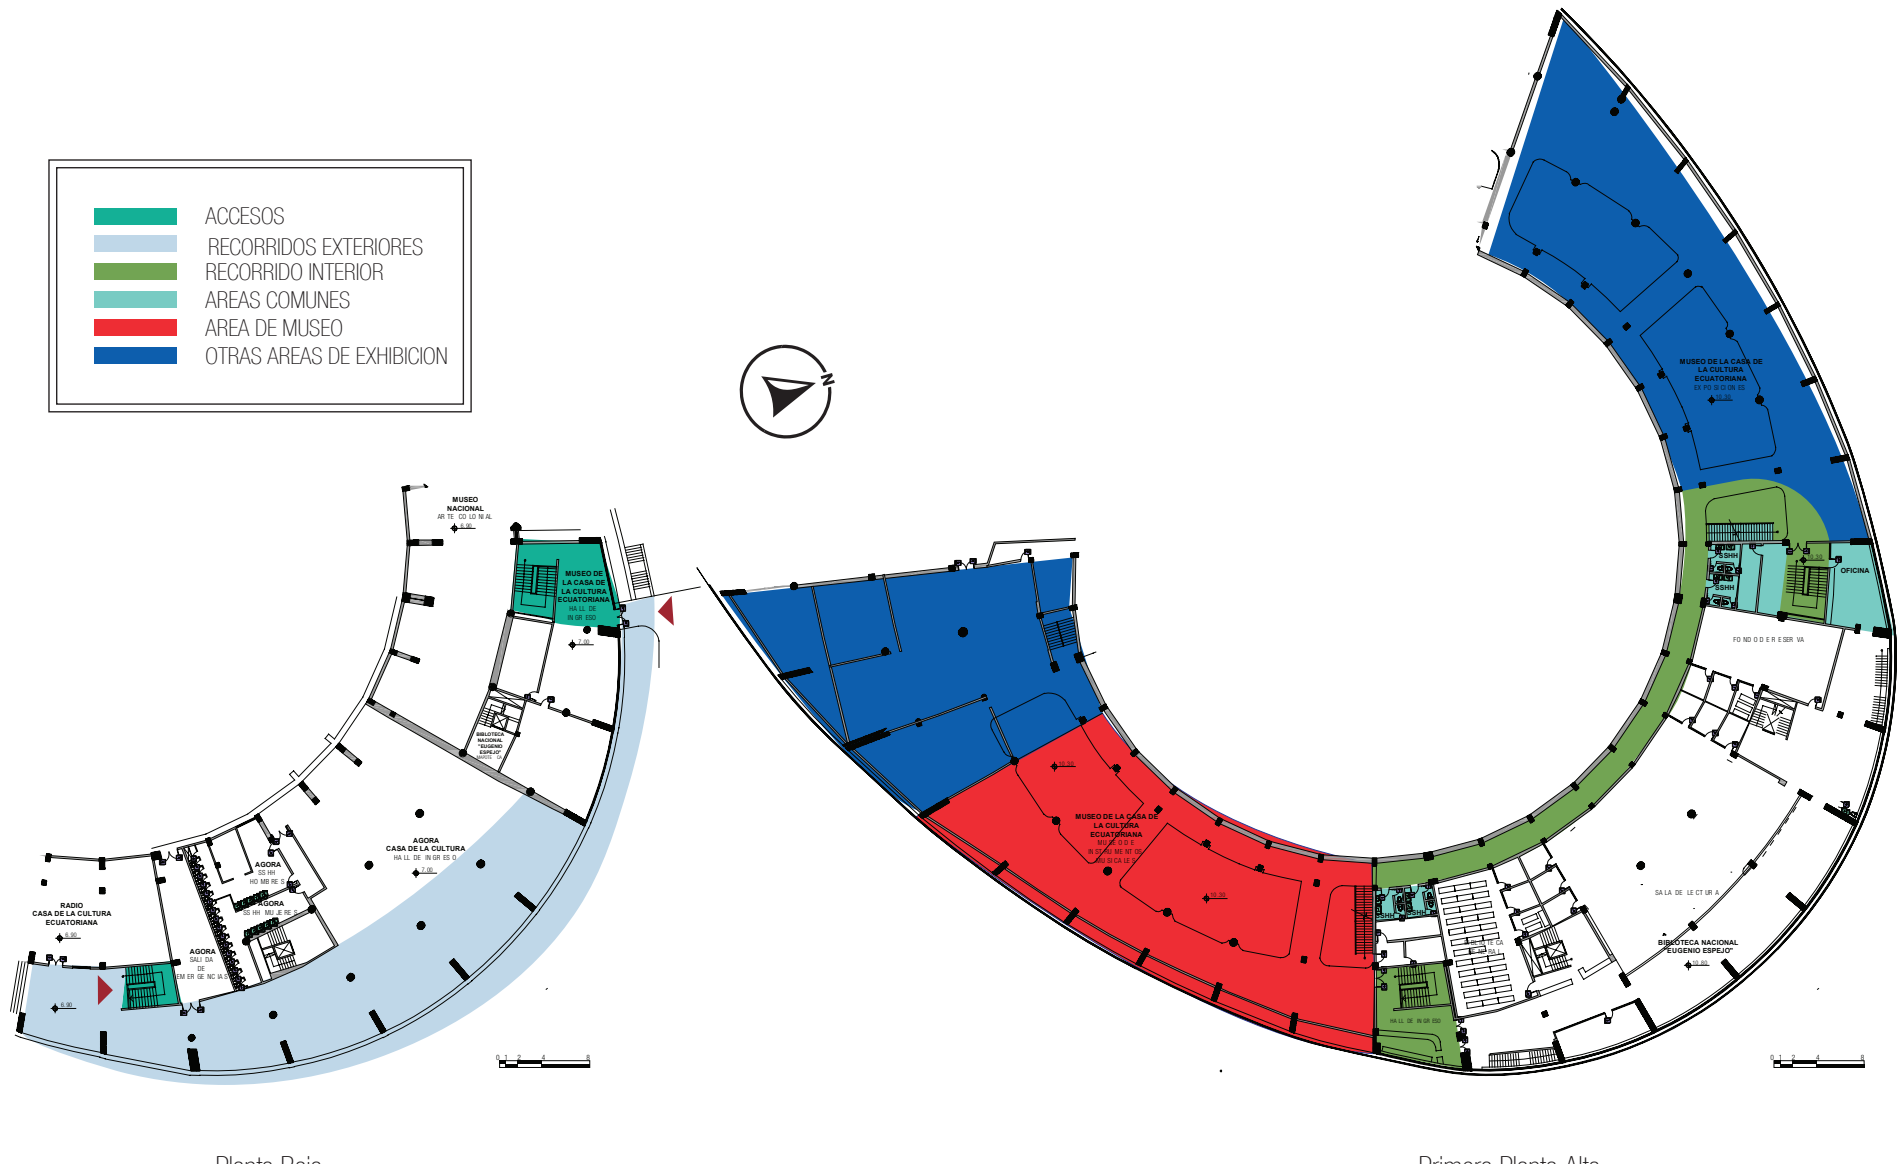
Planta de zonificación Actual. Realizado por; Tanya Briones
